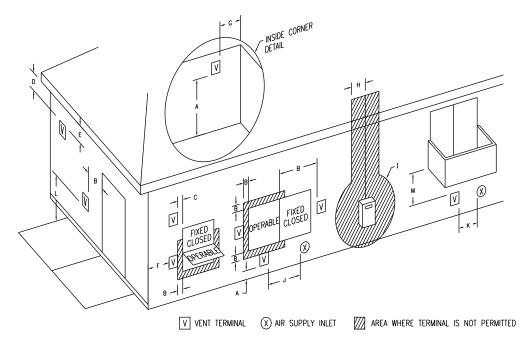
Dégagements des terminaux d'évent (autres que les installations à ventilation directe ou à ventilation directe forcée)
